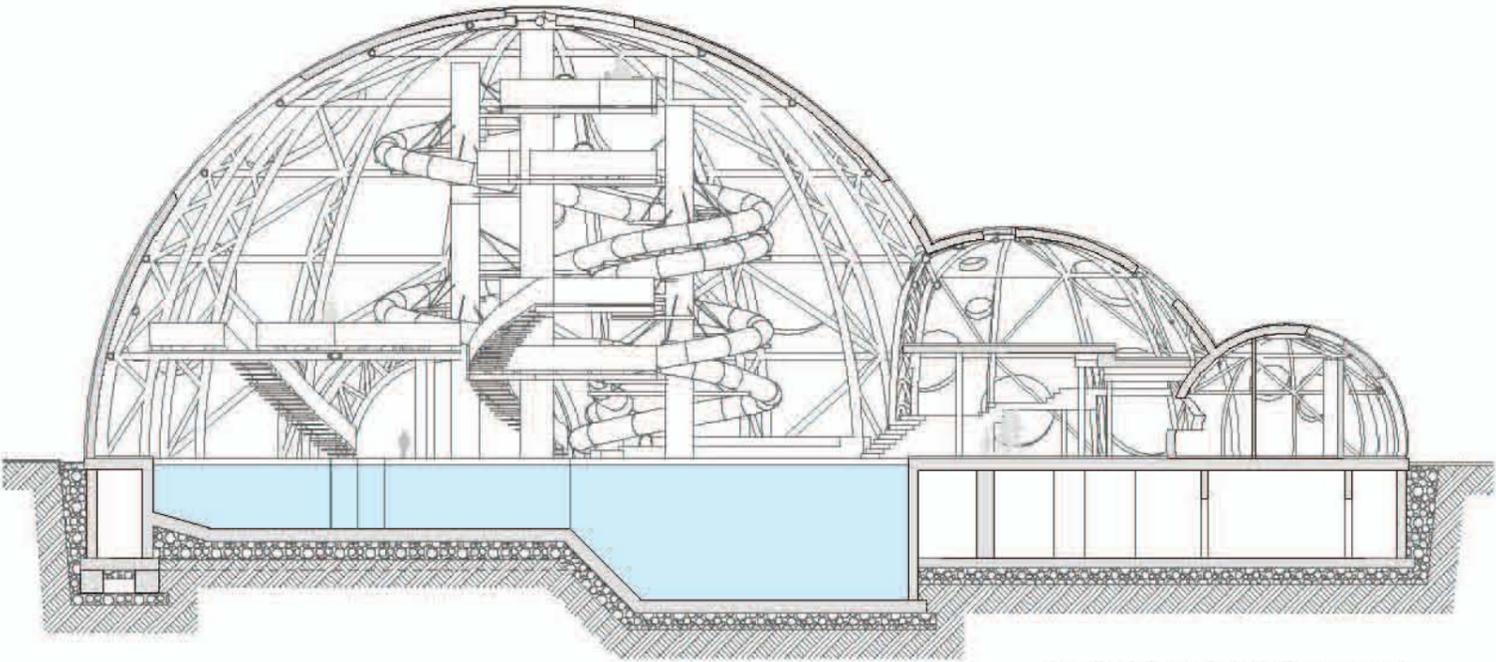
Schnitt F-F Hallenbad - Bistro
